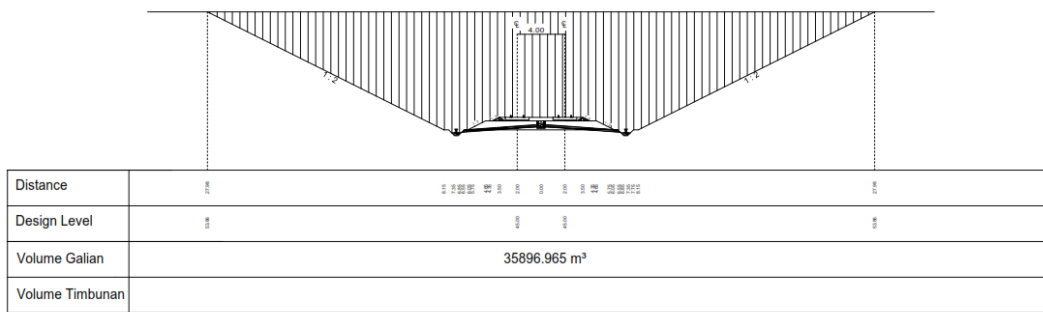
Potongan Memanjang Pada Jalur Tikungan.
